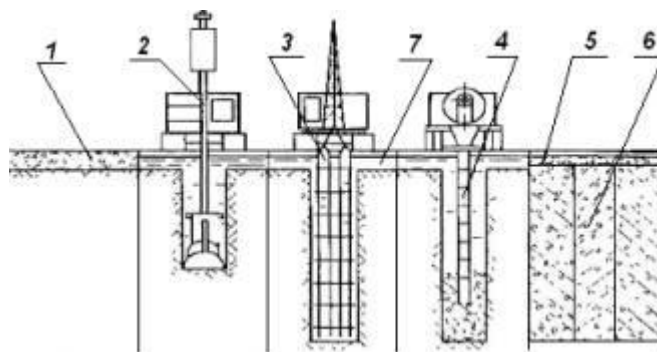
Схема будівництва підземної частини споруди методом «стіна в ґрунті»: 1 - форшахти; 2 - розробка ґрунту в траншейних захватках; 3 - установка армокаркаса; 4 - бетонування методом вертикально переміщуваної труби (ВПТ); 5 - пристрій обв'язувального пояса по периметру; 6 - готова стіна; 7 - глинистий розчин.
